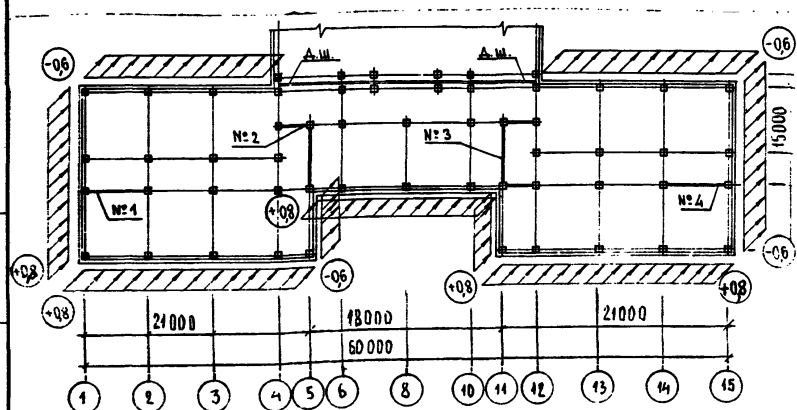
Схема приложения горизонтальной (ветровой) нагрузки под углом 45° к осям здания (вариант III).
